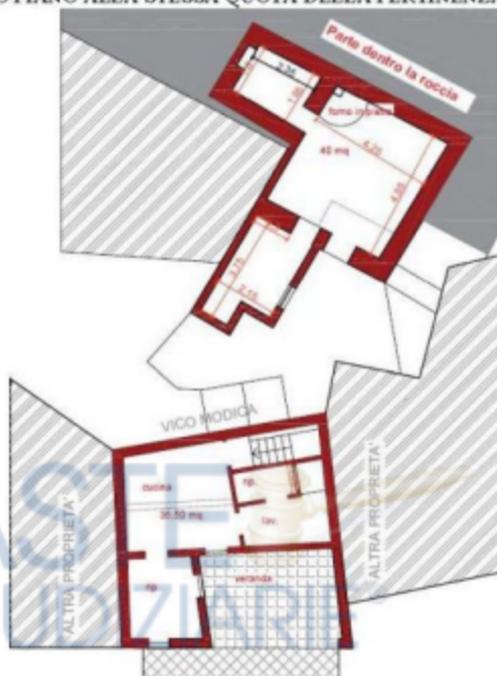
Planimetria dell'esistente rilevata in sede di sopralluogo priva di titolo autorizzativo.
